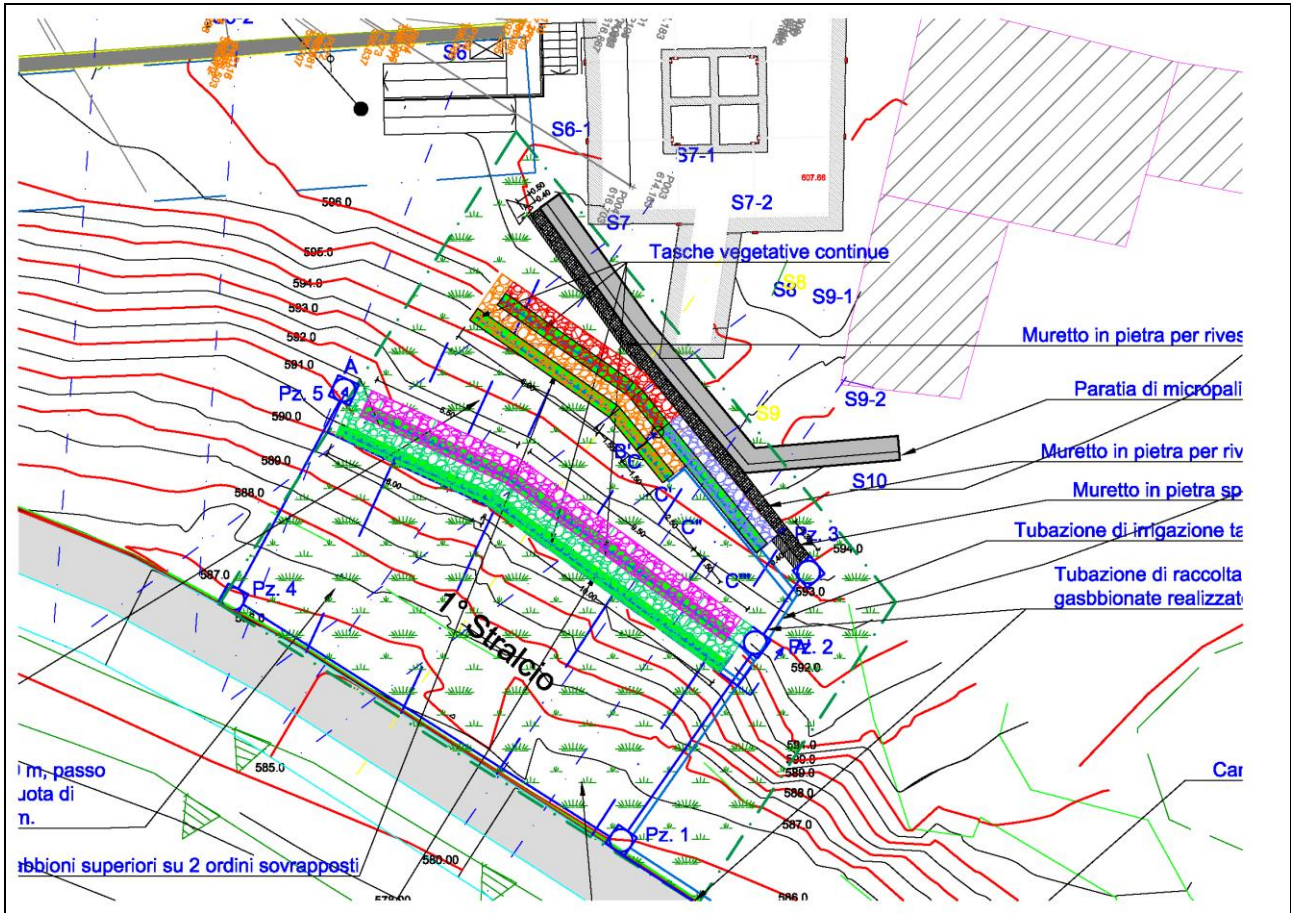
Estratto dalla Tav. N. 15 – PG “Planimetria generale: Stato di Progetto” – Progetto esecutivo – gennaio 2015
